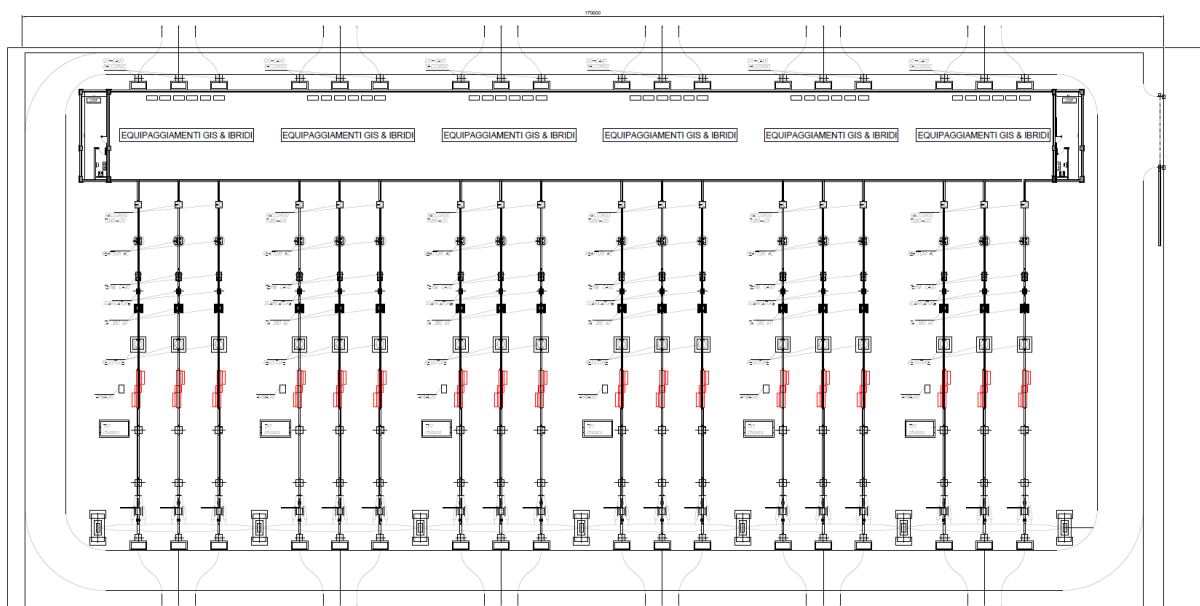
17: Vista in pianta della stazione di compensazione e sezionamento
